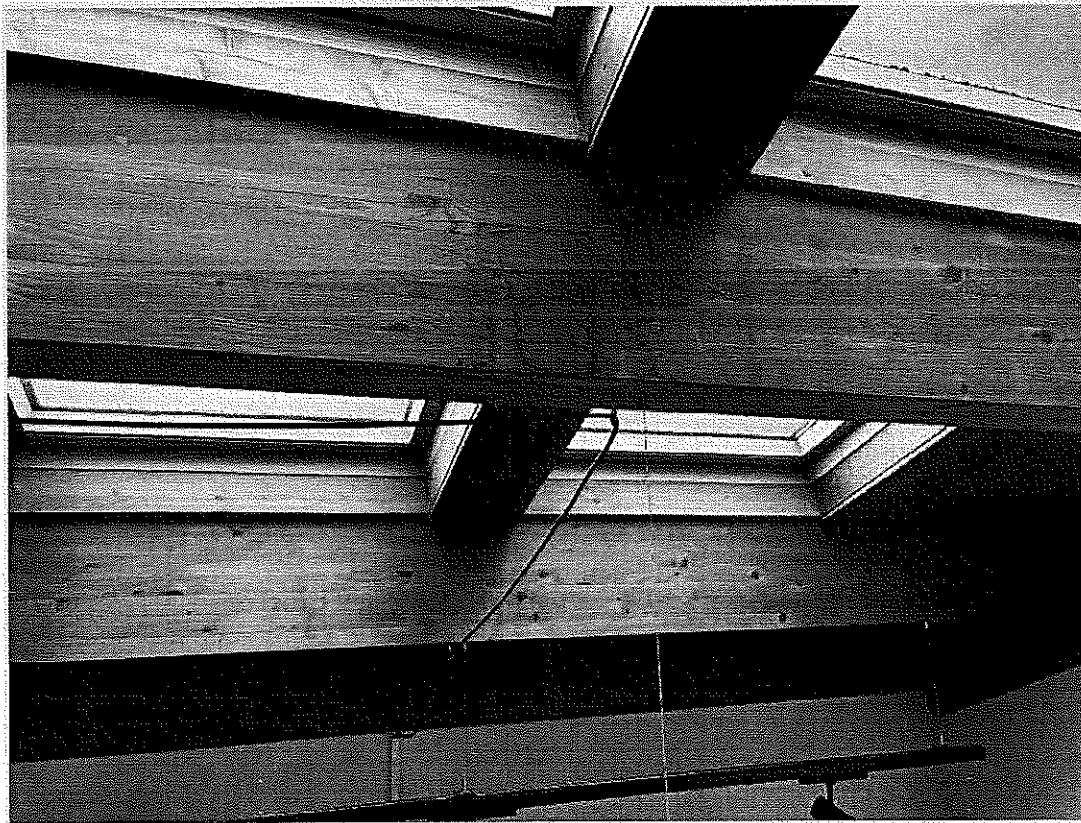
ALONI SU TRAVI SOFFITTO CAUSATE DA INFILTRAZIONI
